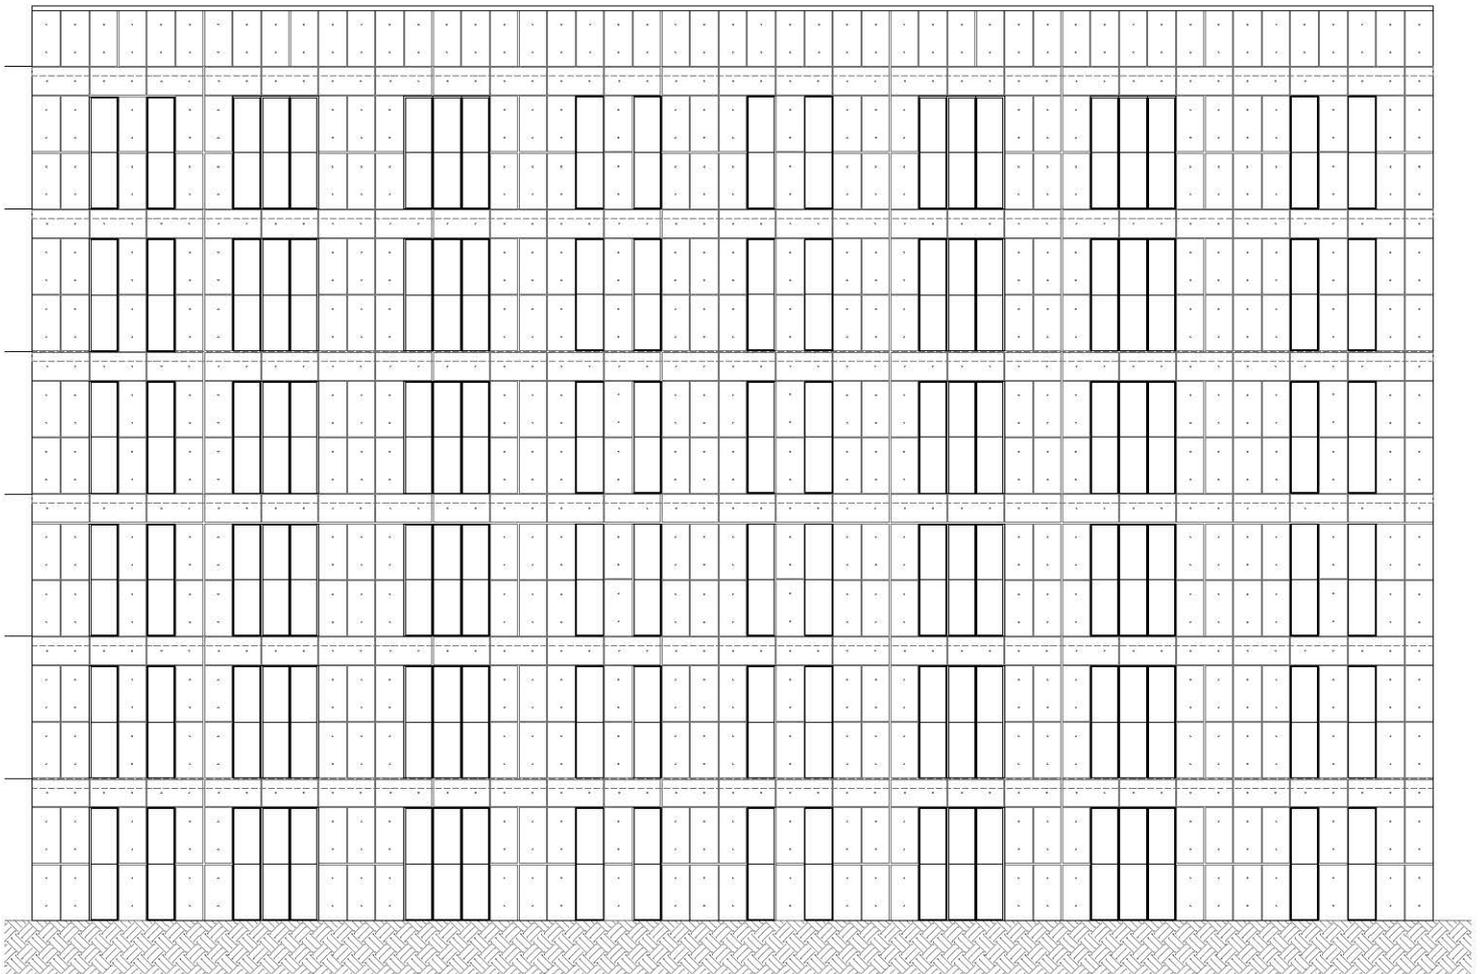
Fachada del nuevo edificio 3-B de cara a la plaza del conjunto
